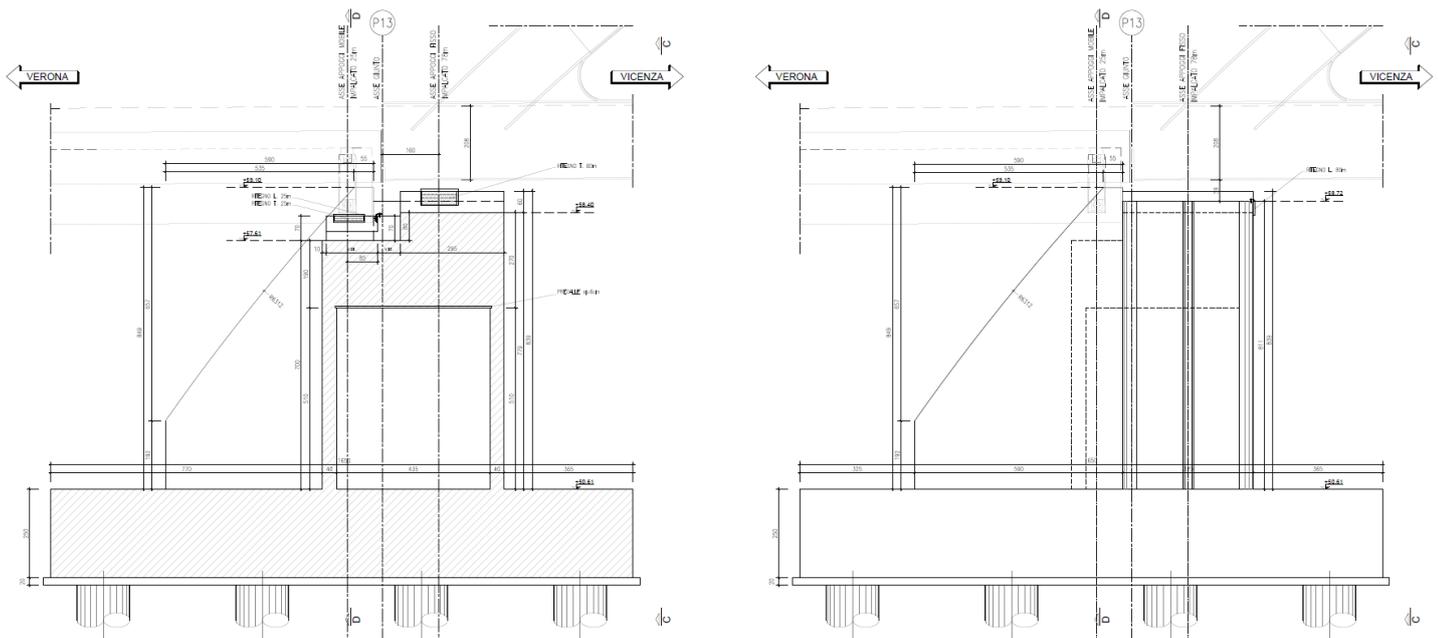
Sezione (a sinistra) e prospetto (a destra) longitudinali rispetto all'asse del viadotto
